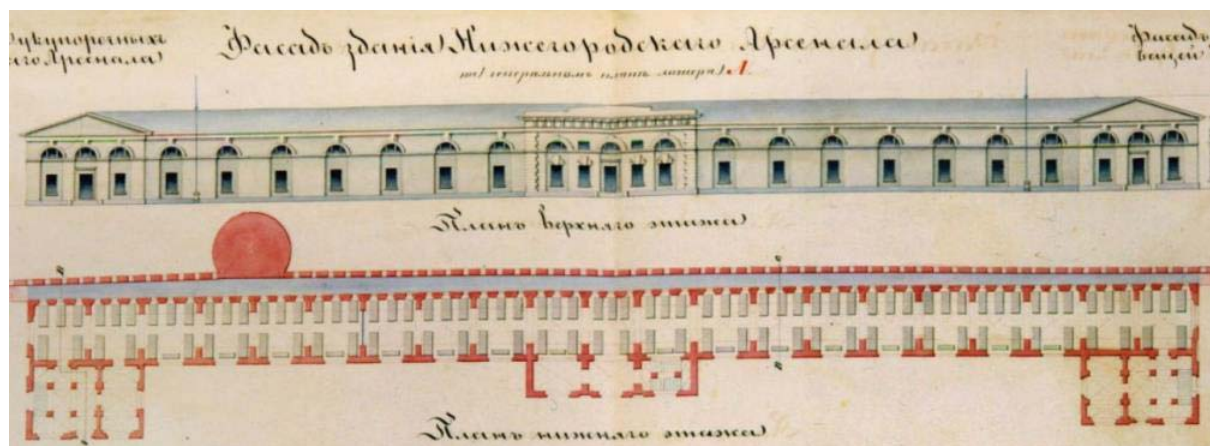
Фрагмент чертежей Арсенала. Фасад и план
